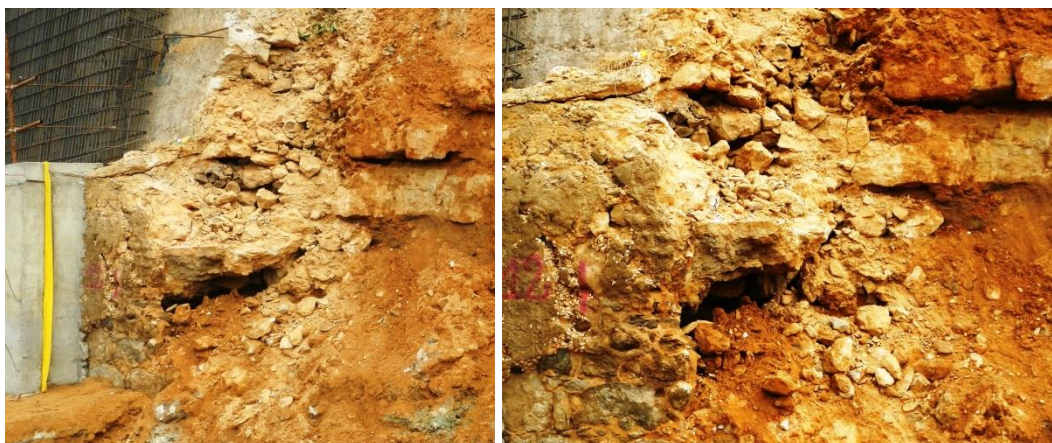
Loca na zona Norte da rotura do muro de contenção
